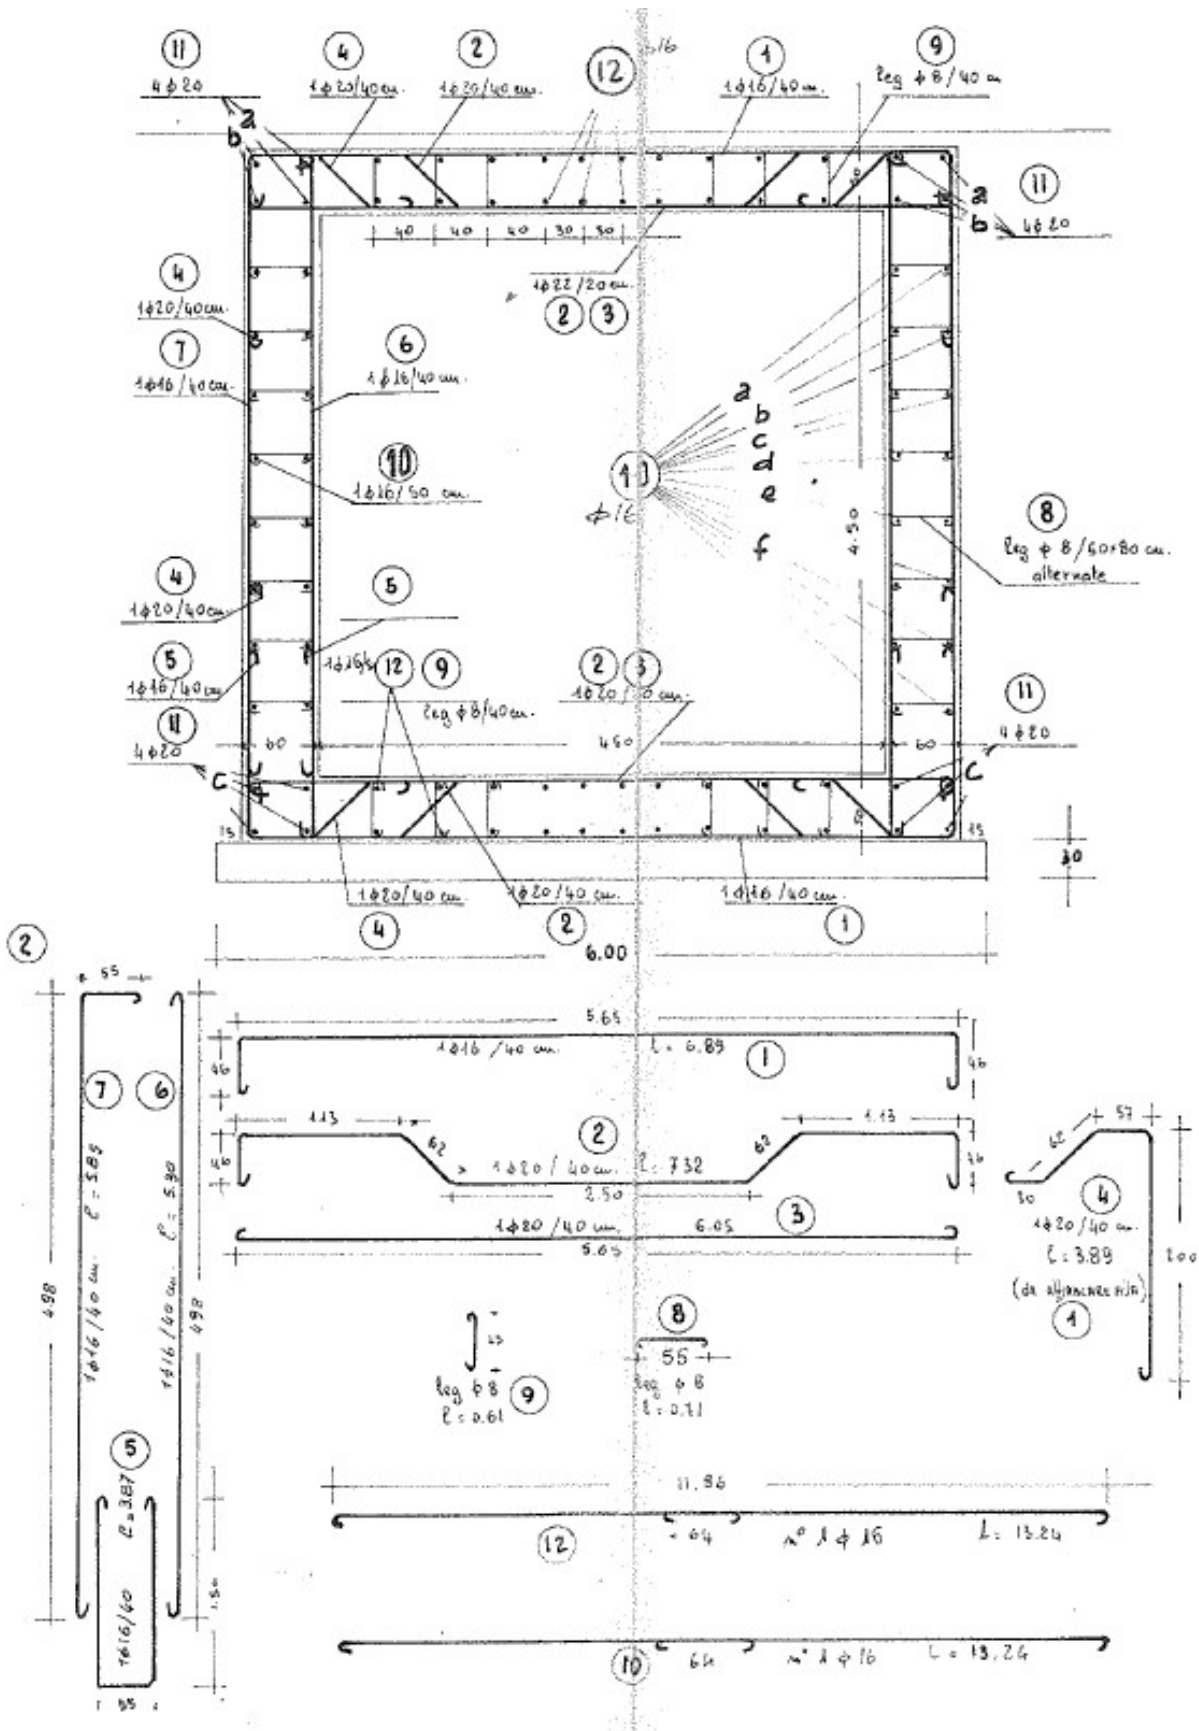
Documento as-built “Manufatto n.25 – Sottovia scatolare in sin. Savena – prog. Km 21+280” – Sezione trasversale con armature
